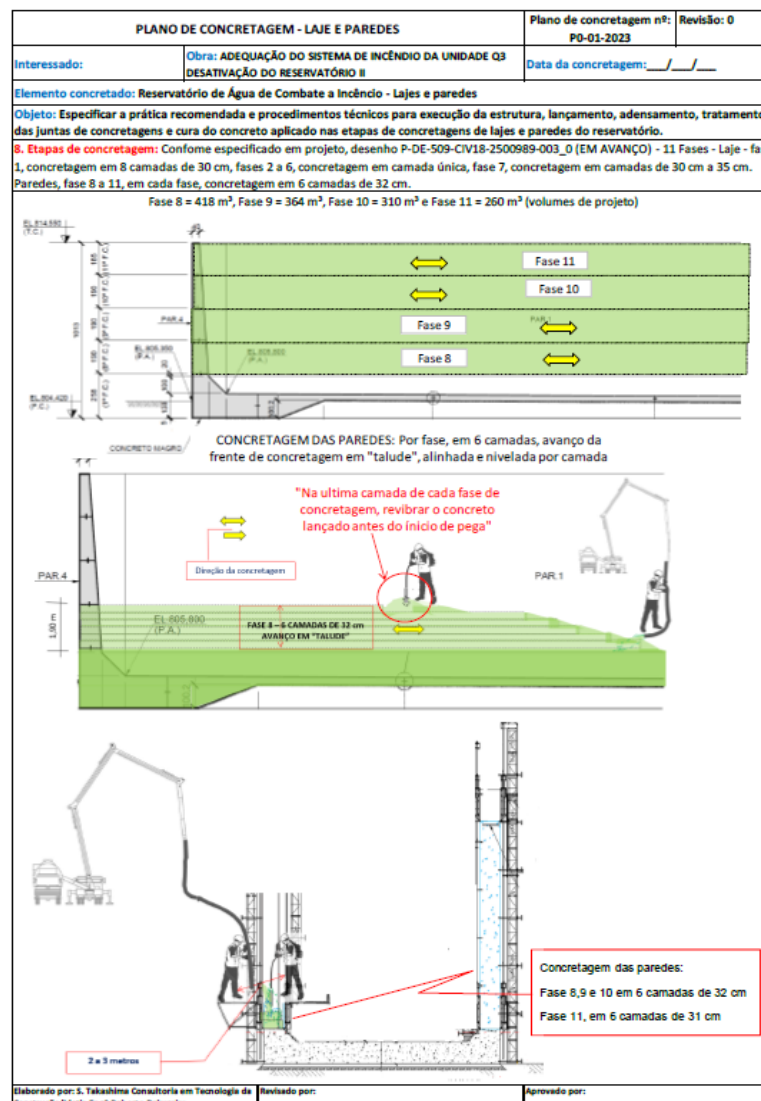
Plano de concretagem (Fonte: Arquivo S, Takashima).
